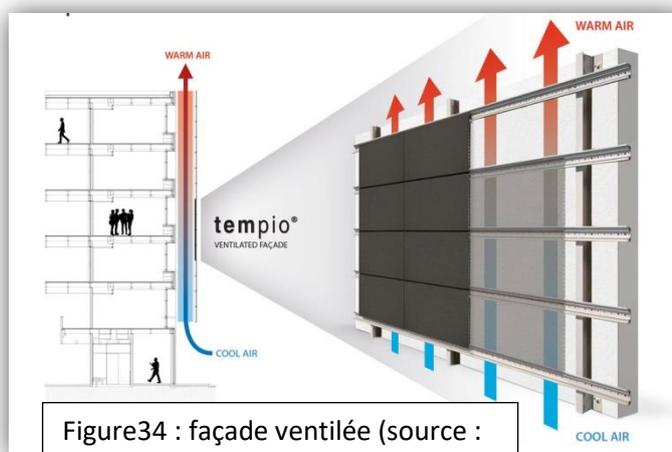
façade ventilée (source : <http://www.tempio.es/fr/facades->
